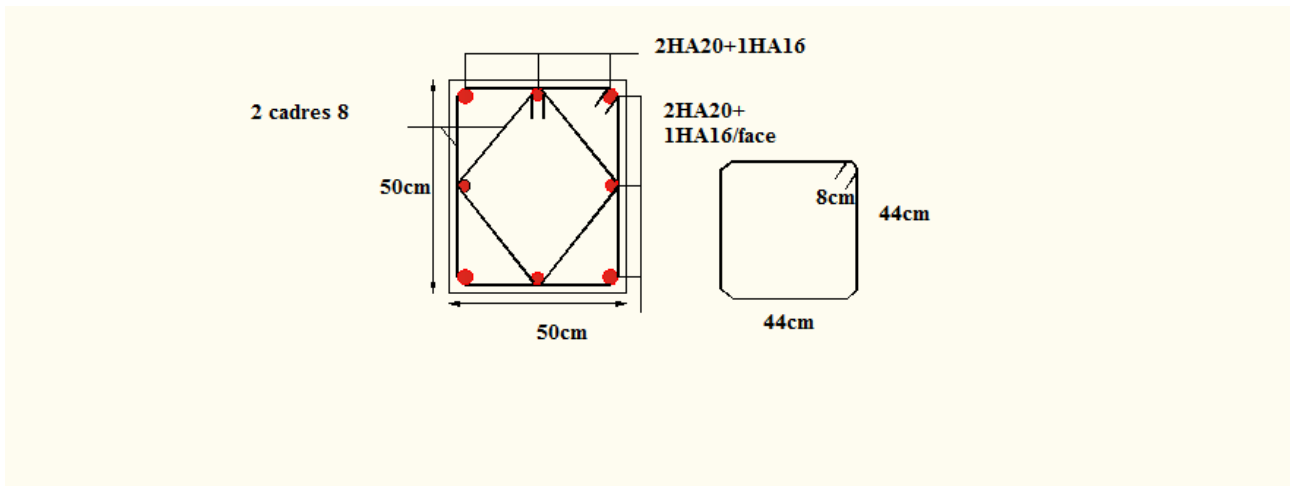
Schéma de ferrailage des poteaux de 1^{er} niveau duplexe.
